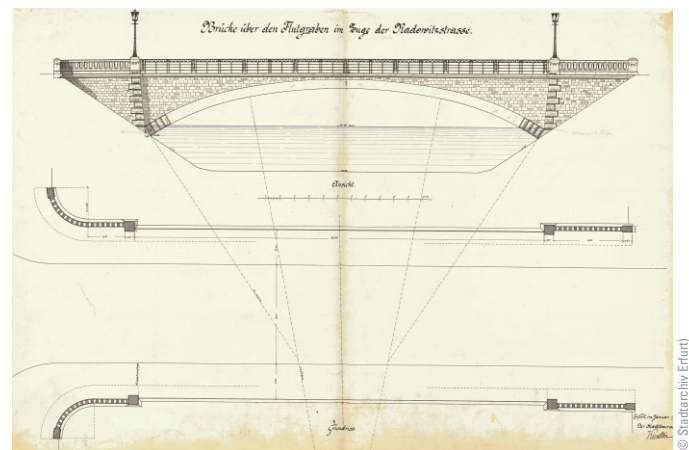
Radowitzbrücke – Bauwerksplan – HERMANN KICKTON – 1906
